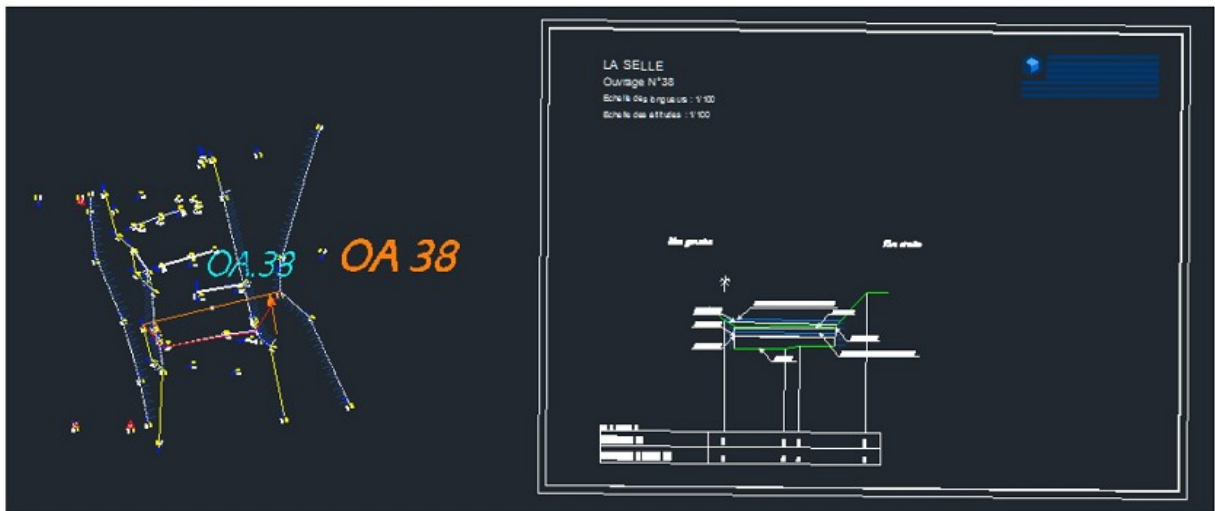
Exemple de fichier Autocad contenant les coupes d'ouvrage géo-référencées
